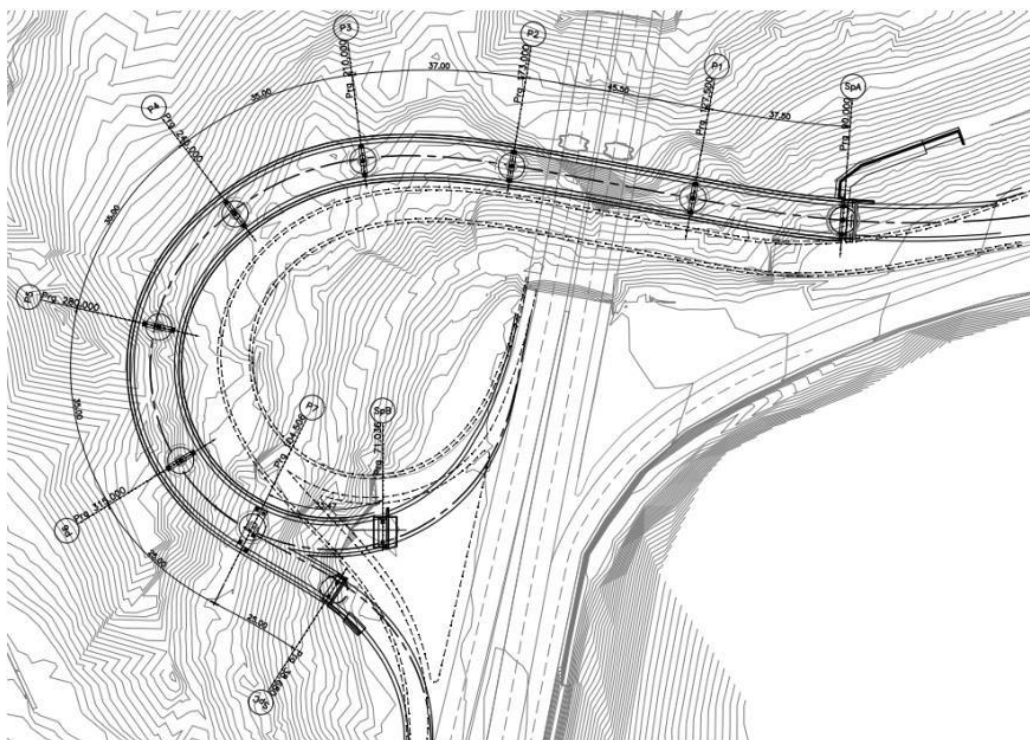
Planimetria del nuovo viadotto Tornimparte – il tratteggio indica l'attuale viadotto
